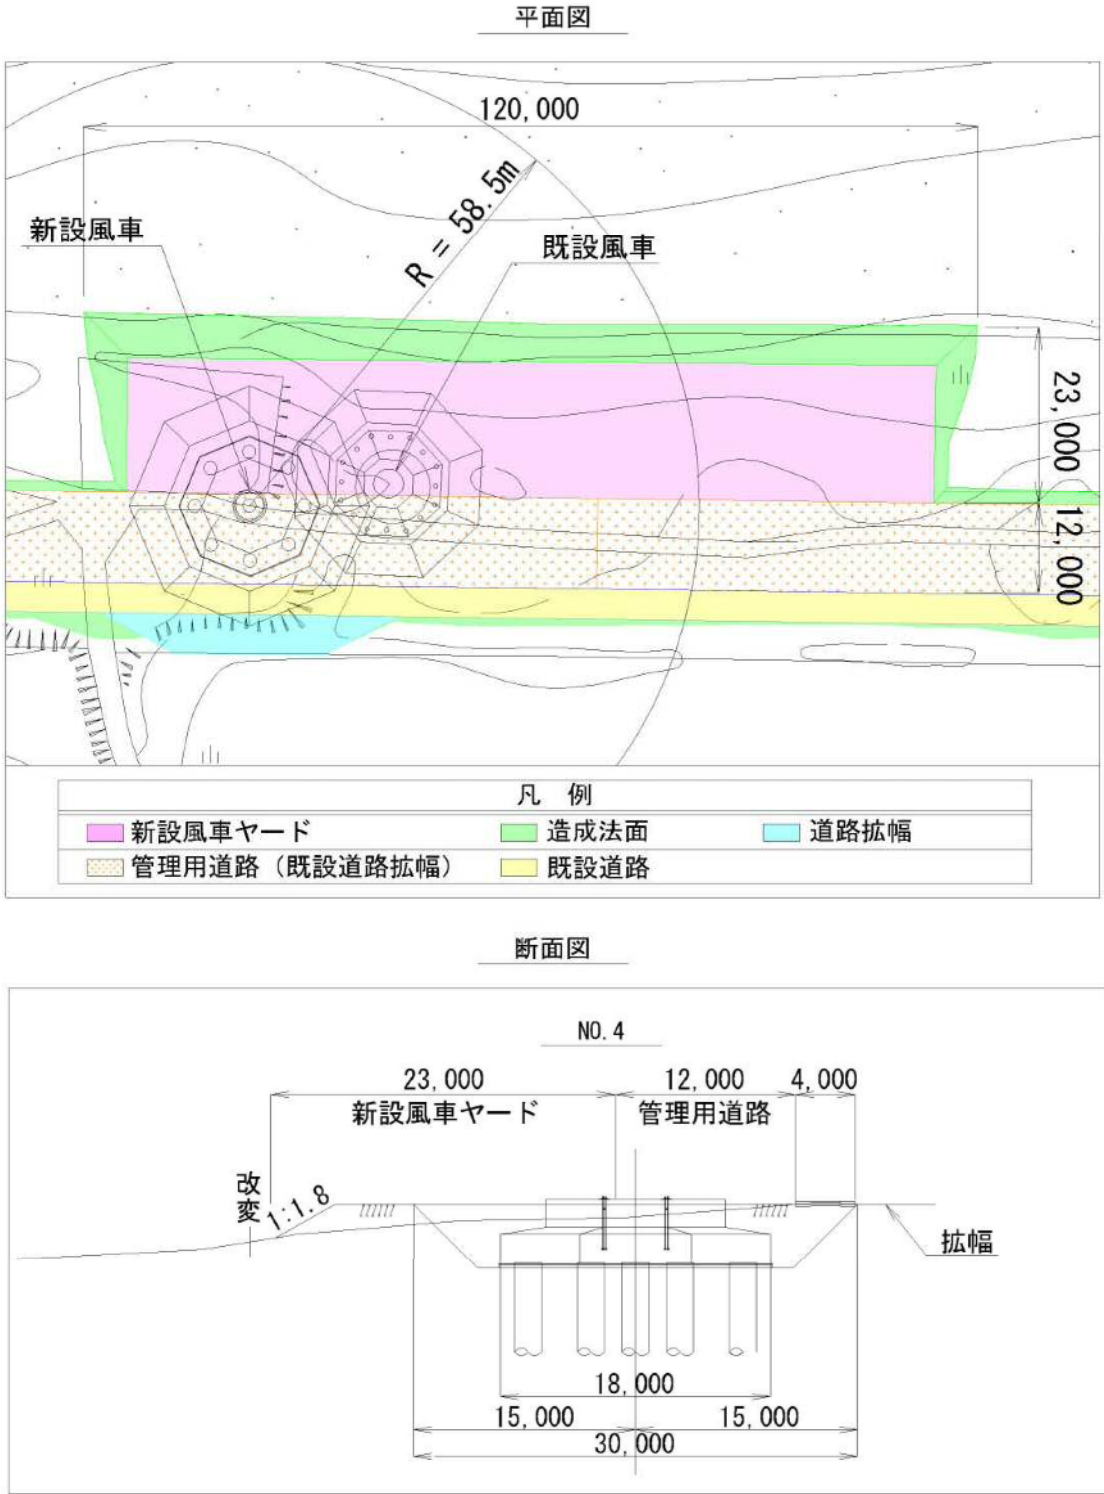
(4) 造成平面・横断計画図（新設 4 号機）
